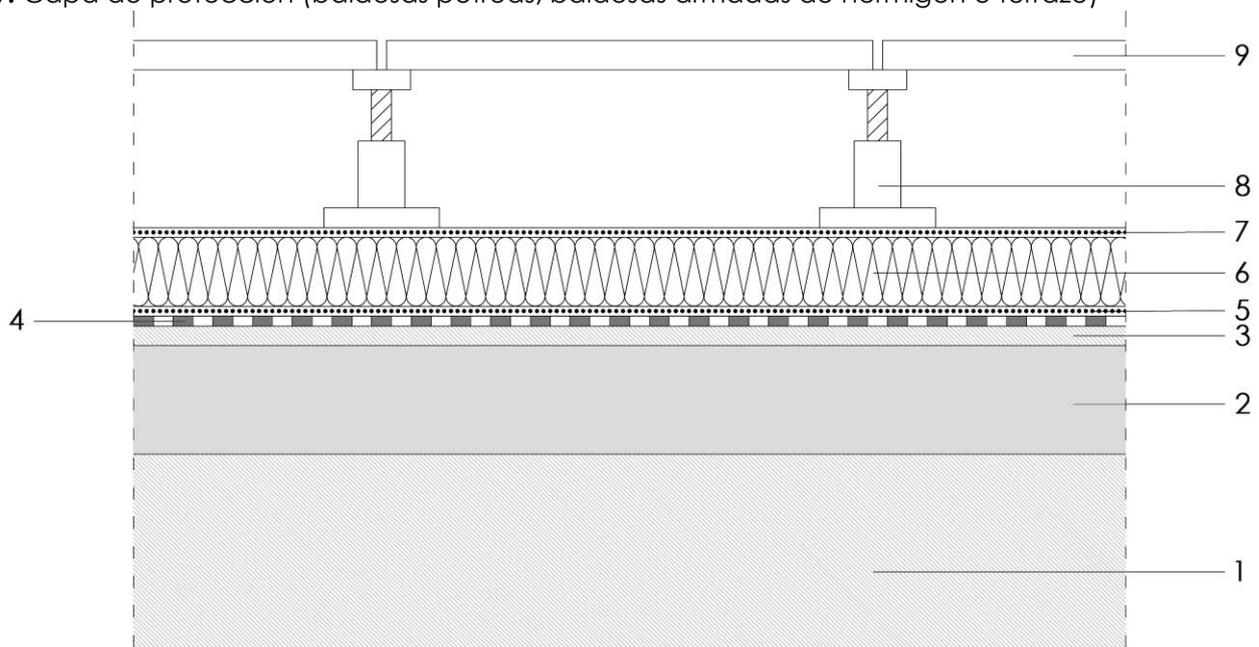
Detalle constructivo de cubierta invertida con acabado flotante.
